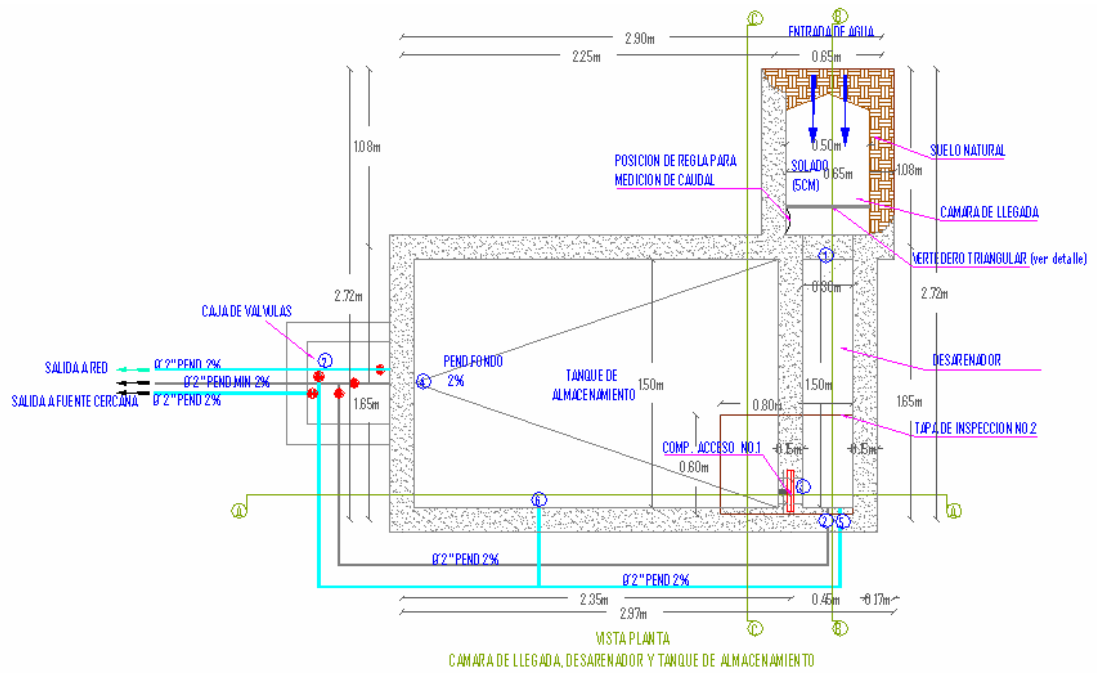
Vista en planta Cámara de llegada desarenador y tanque de almacenamiento.
